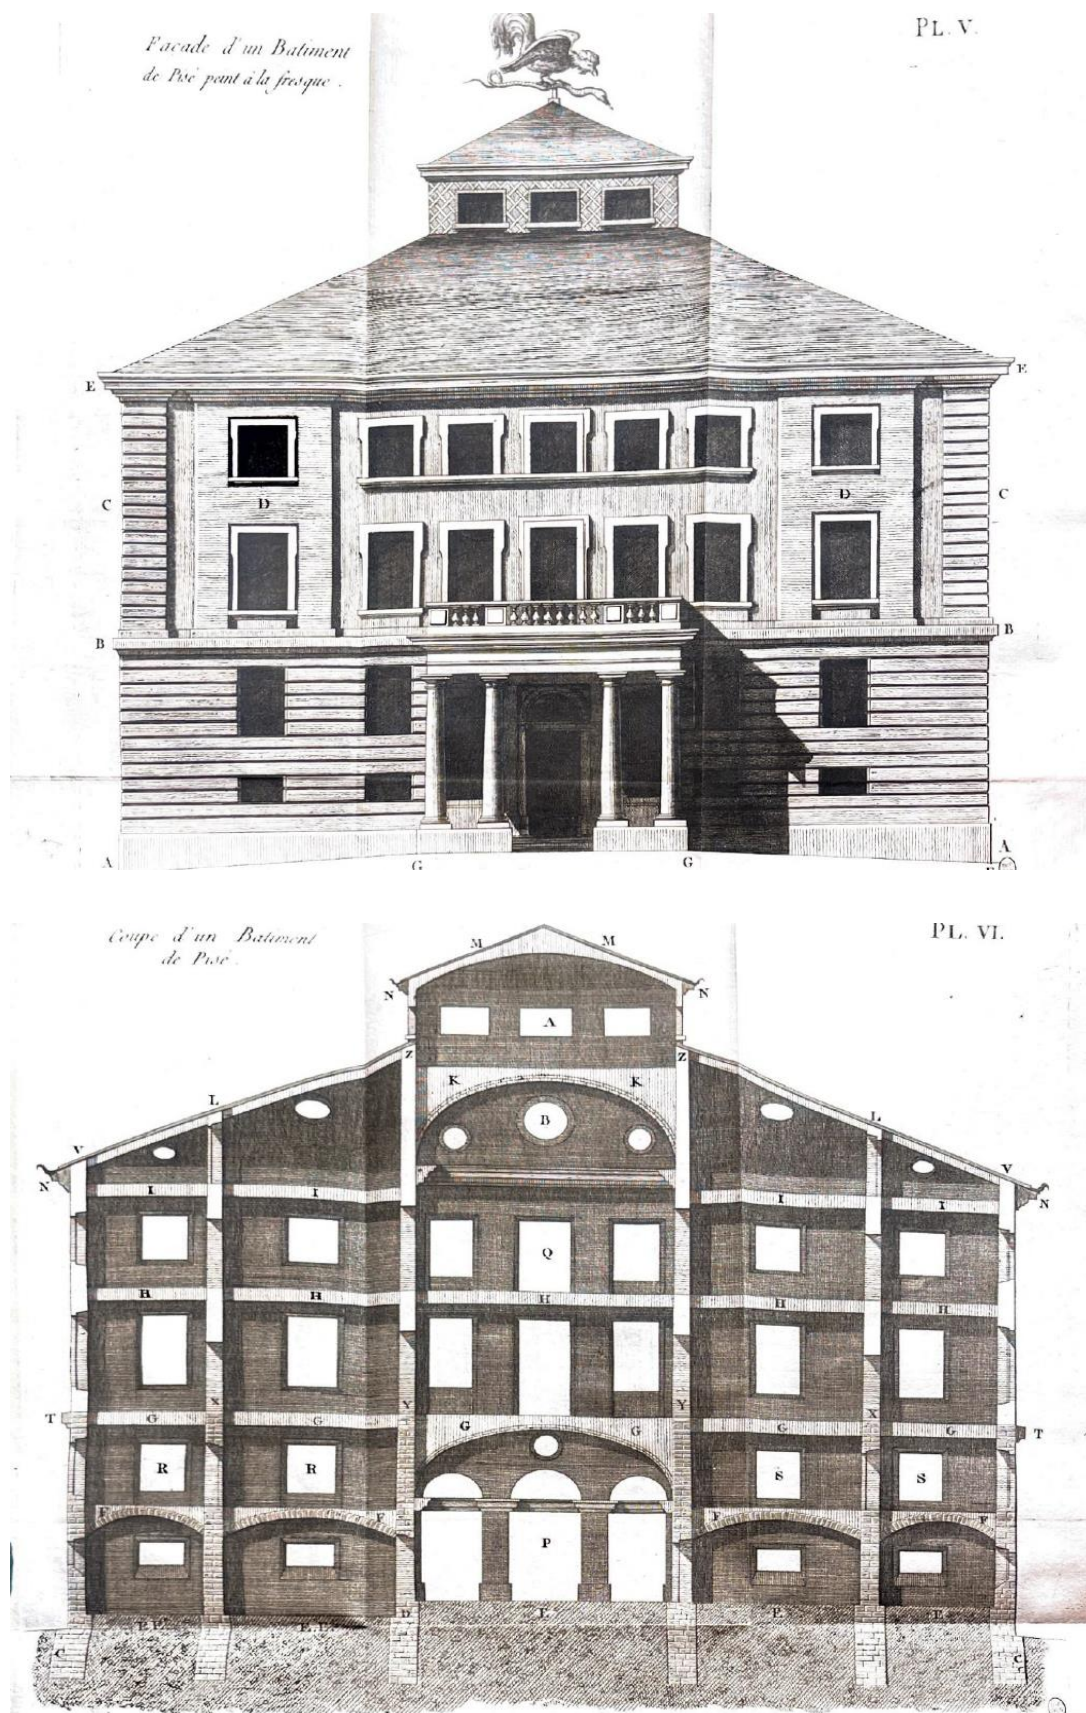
et 38 : Dessins : Façade (Pl. V) et coupe (Pl. VI) de la Maison de Bresse en pisé, montrant l'usage d'enduits imitant la pierre ainsi que les planchers en bois et murs porteurs en béton de terre.
